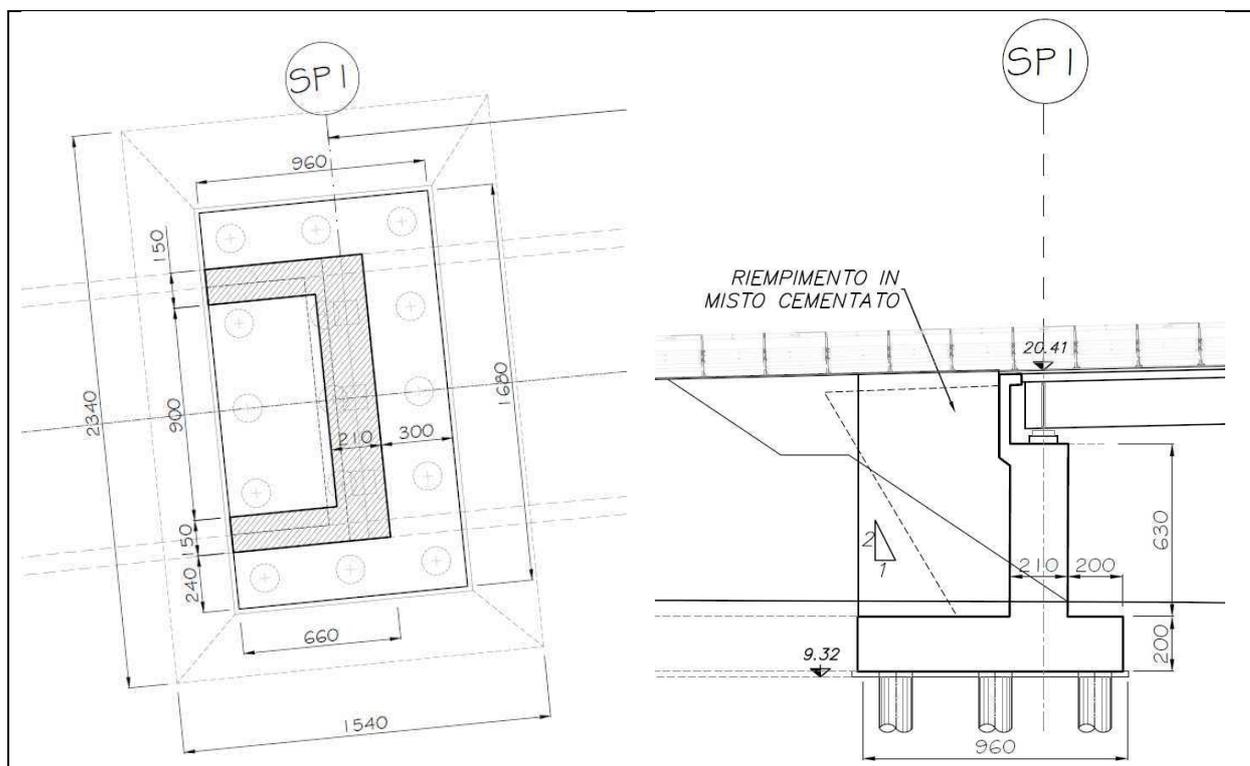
Spalla 1 - Pianta Fondazioni Sezione Fondazioni
